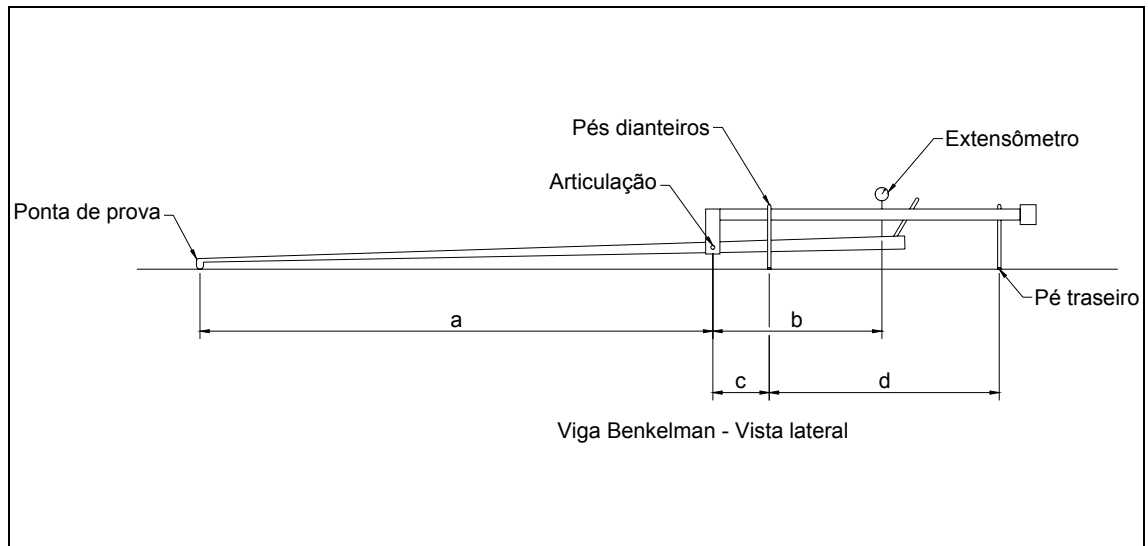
Viga Benkelman (DNER ME024-94)
